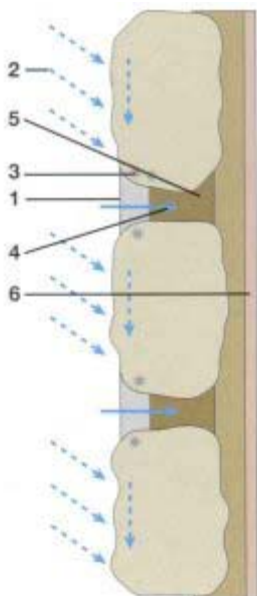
Refecimento de juntas com Cimento – Alvenaria de Pedra Porosa
